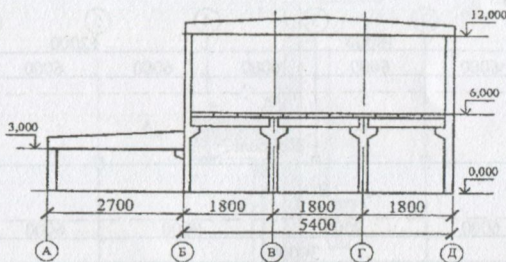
Поперечний переріз будівель, зображених на рис. 4.8
